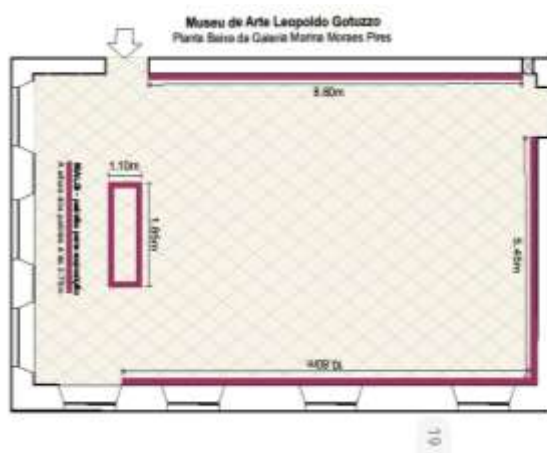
Planta Baixa Galeria de Marina Moraes Pires.
